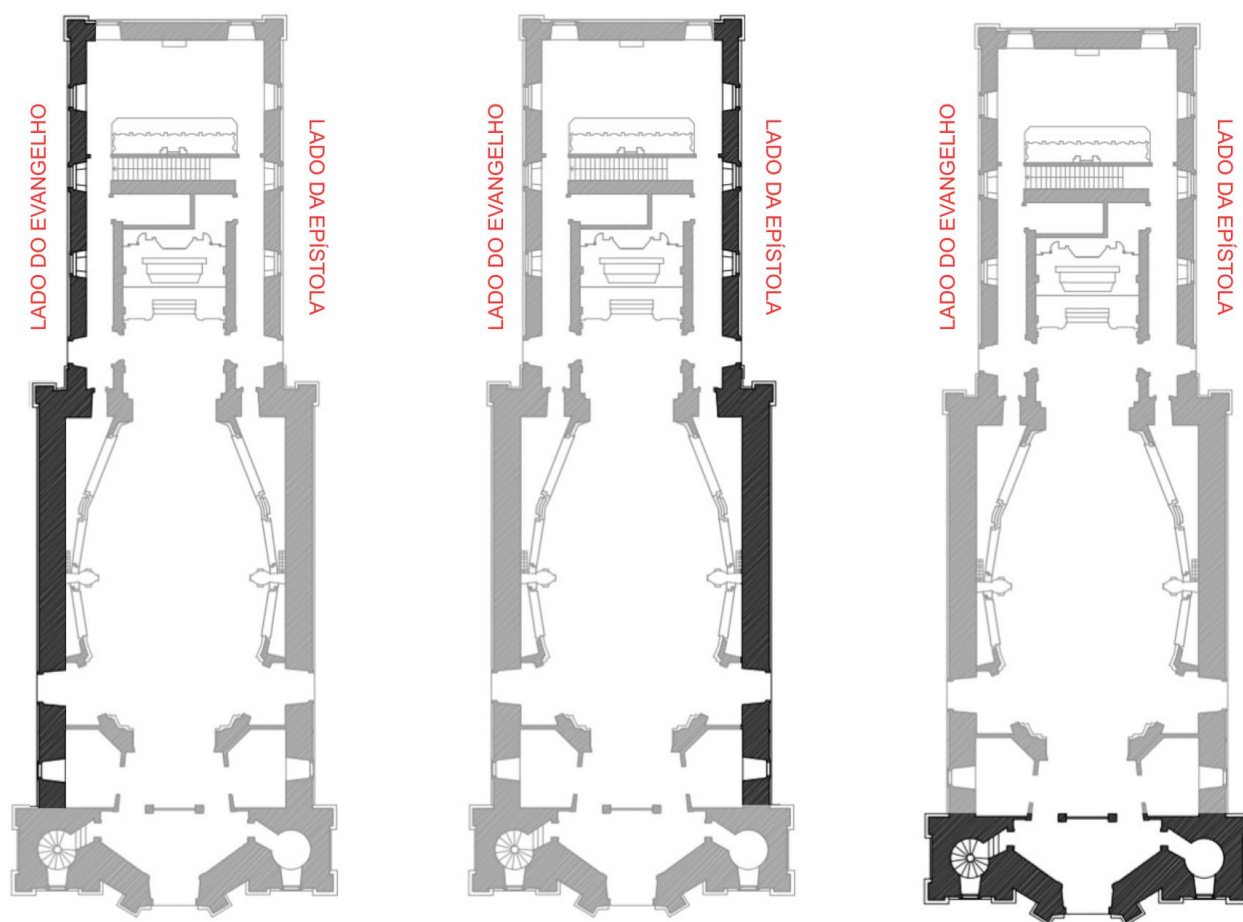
Planta da Matriz do Pilar - Ouro Preto (MG)
